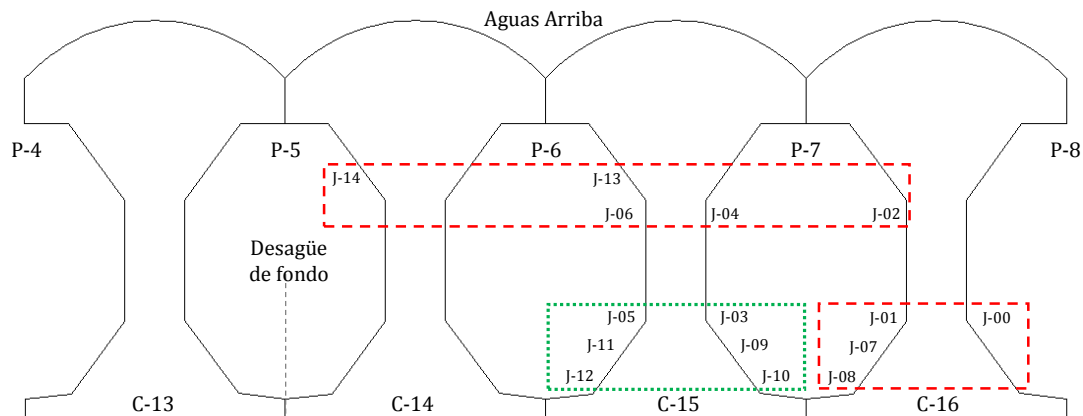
En rojo fisuras que se abren, en verde fisuras que se estabilizan o se cierran
